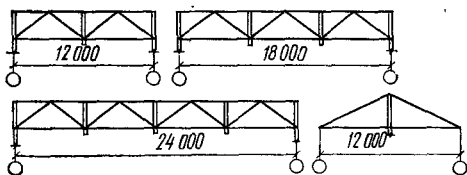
Схемы подстропильных ферм различных пролетов (справа внизу схема фермы с элементами из круглых труб)
